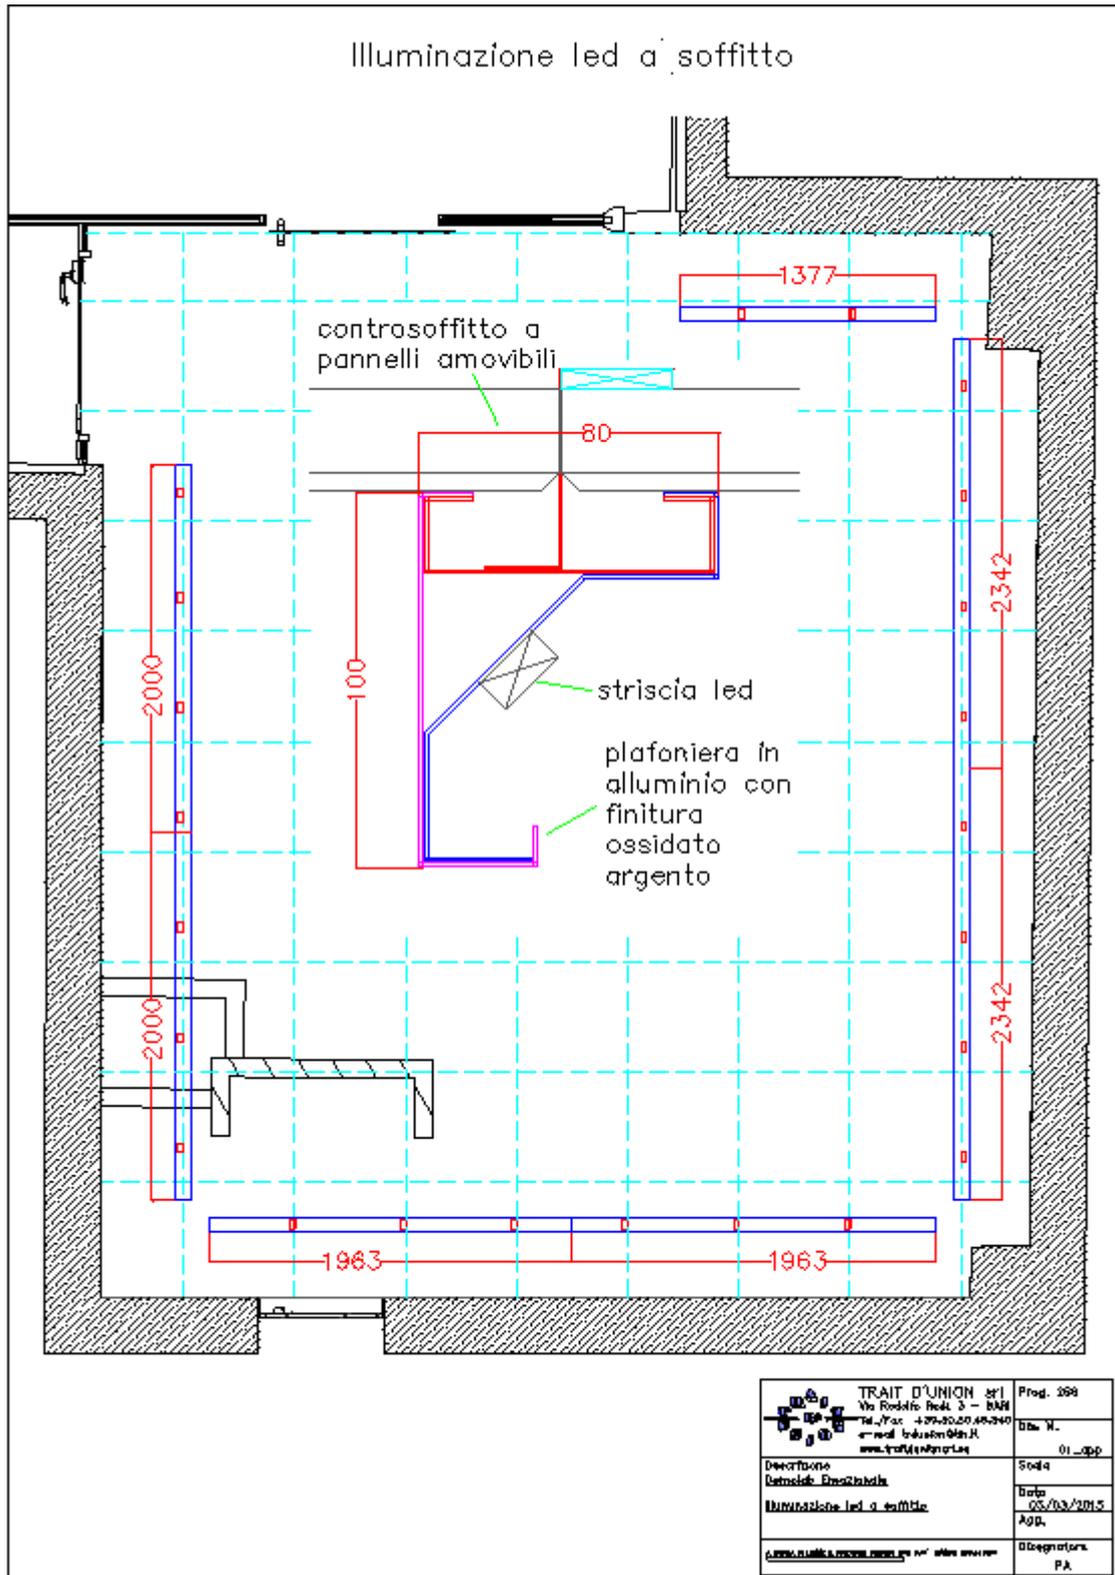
VISTA PLANIMETRICA DELLA SALA PRESIDENZA DI AMT SERVICES CON LE PLAFONIERE A SOFFITTO POSIZIONATE
